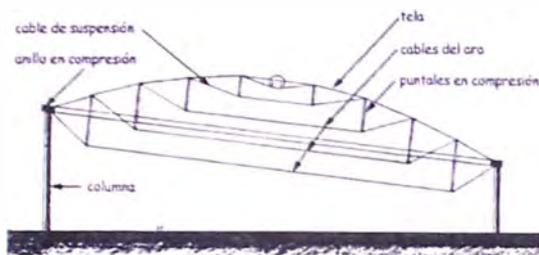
Tomado de: Fuller Moore, Libro: Compresión de las Estructuras en Arquitectura, Florida Suncoast Dome, Sección
